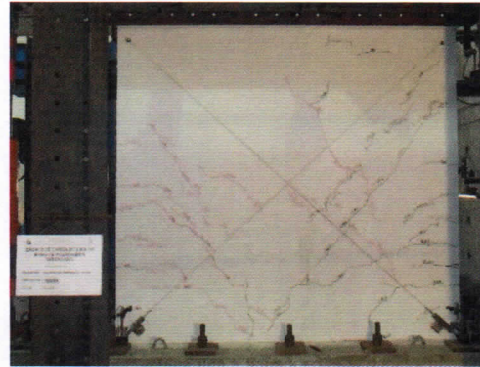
Nuevas grietas diagonales paralelo a la diagonal principal para una distorsión 1/800 Vista cara Norte.
